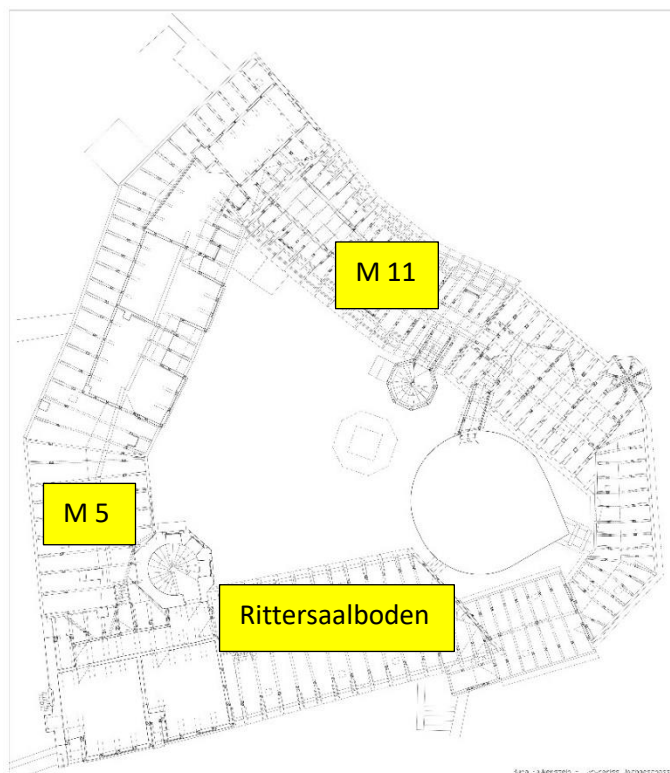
Burg Falkenstein. Grundriss Dachgeschoss mit Lokalisierung der Räume zur Probenahme
